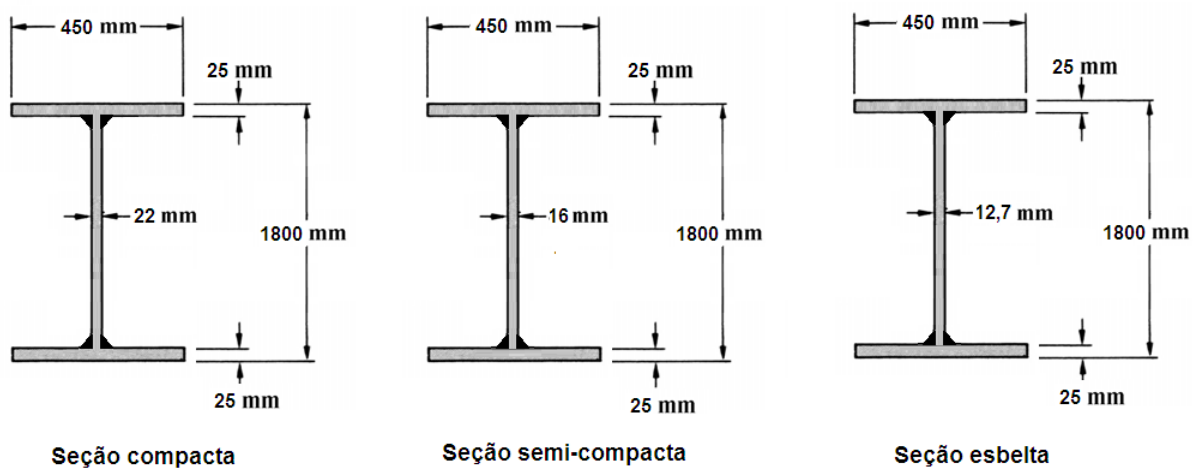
Detalhe das seções transversais em aço utilizadas para cada ponte mista analisada.
